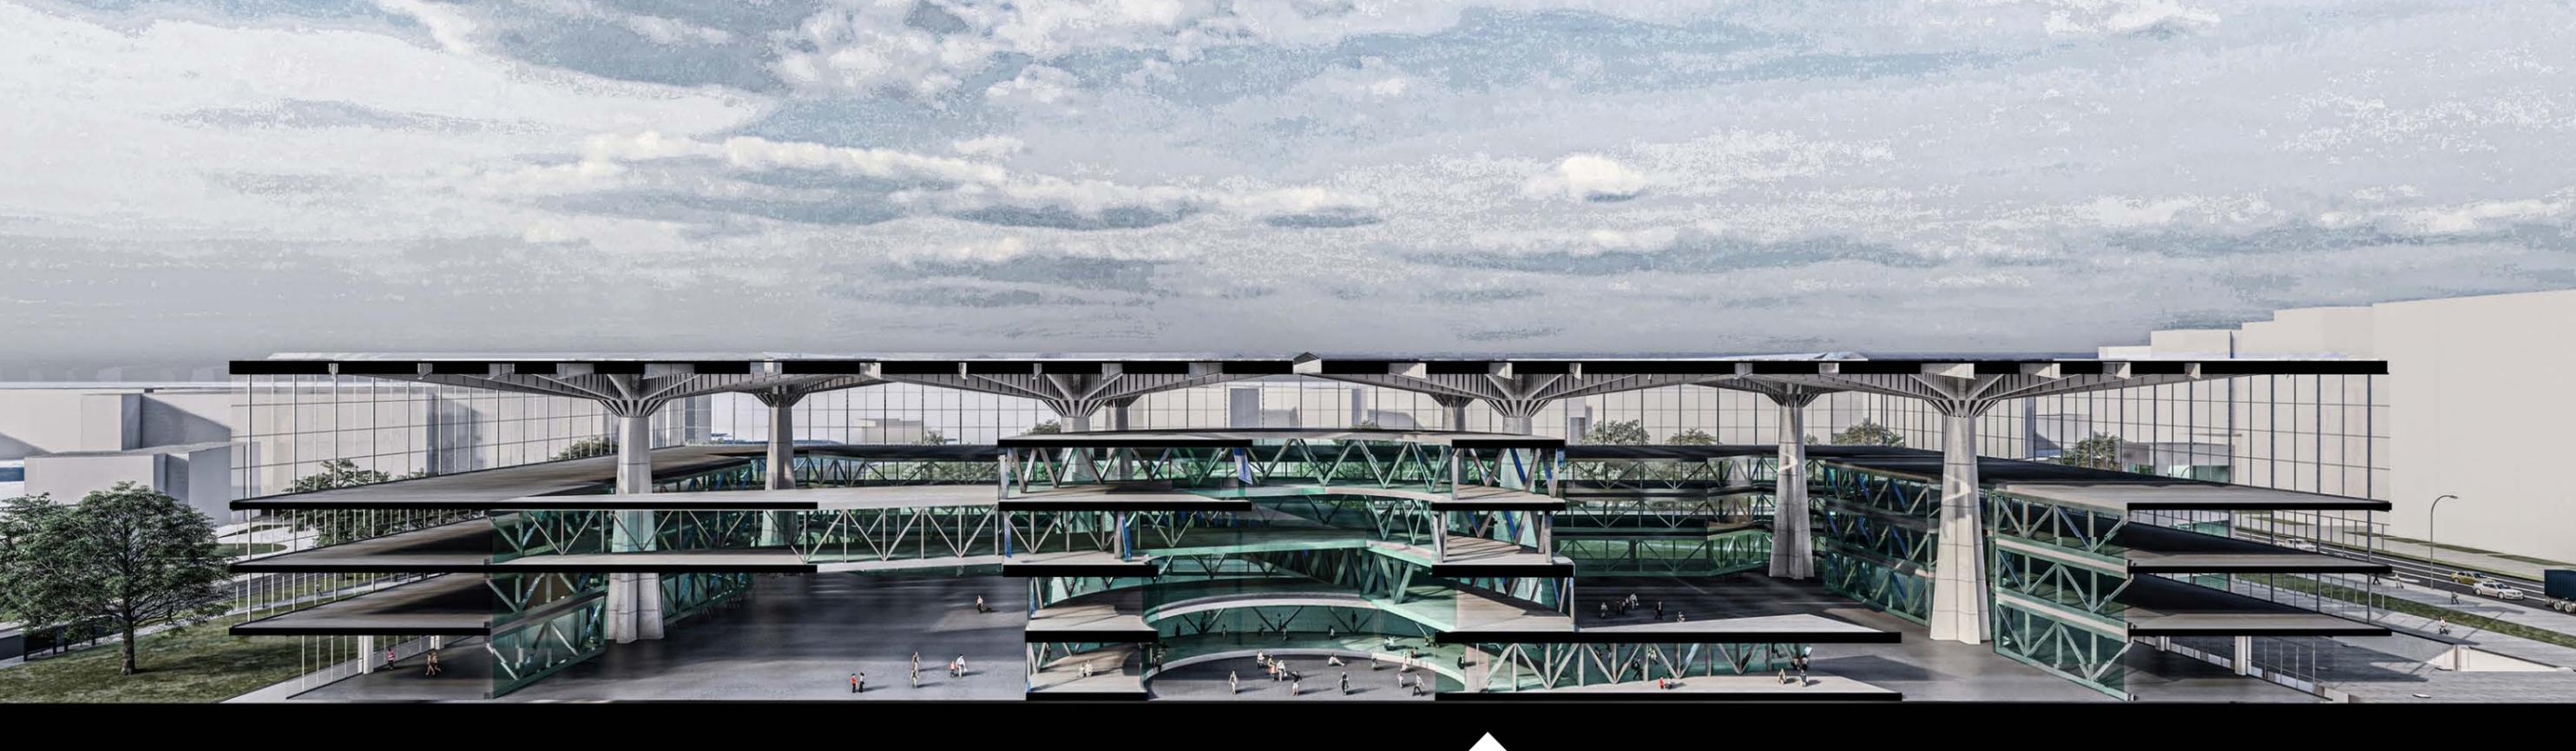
Sezione prospettica rappresentante il rapporto tra la struttura nervata e il progetto di riqualificazione.
